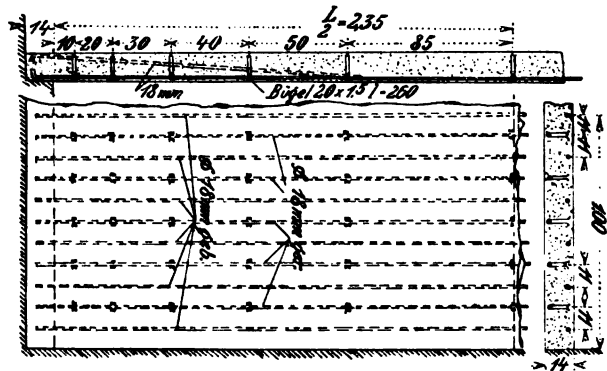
bis 145. Grundriß, Quer- und Längenschnitt einer Hennebique-Platte.
